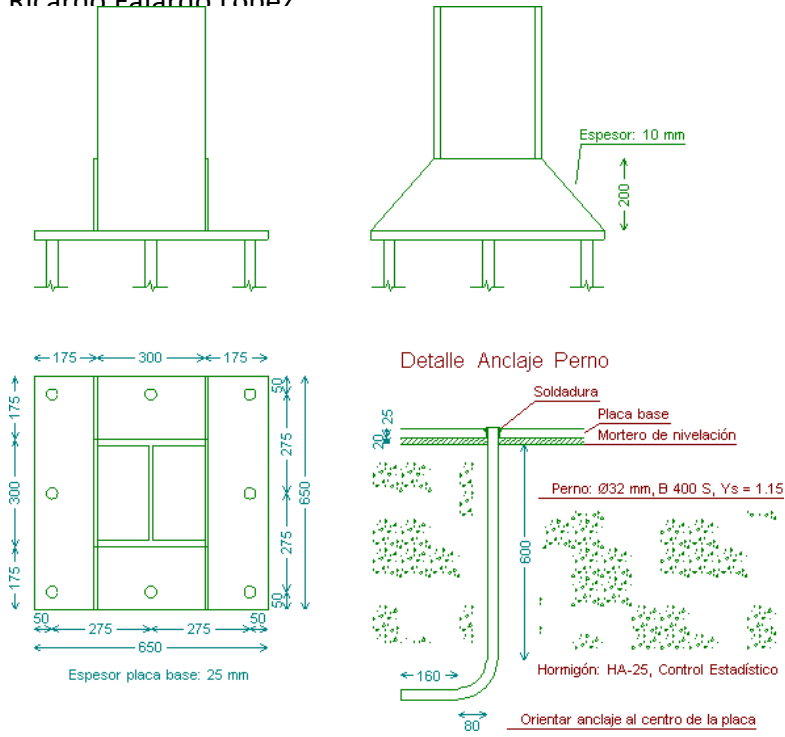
Geometría de la placa de anclaje de los pilares de un PÓRTICO TIPO.
